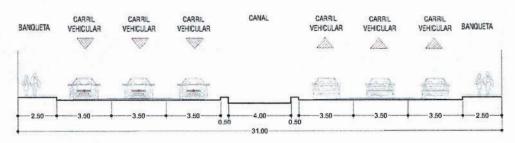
Av. Homero y su sección vial. Fuente PDU 2040.
